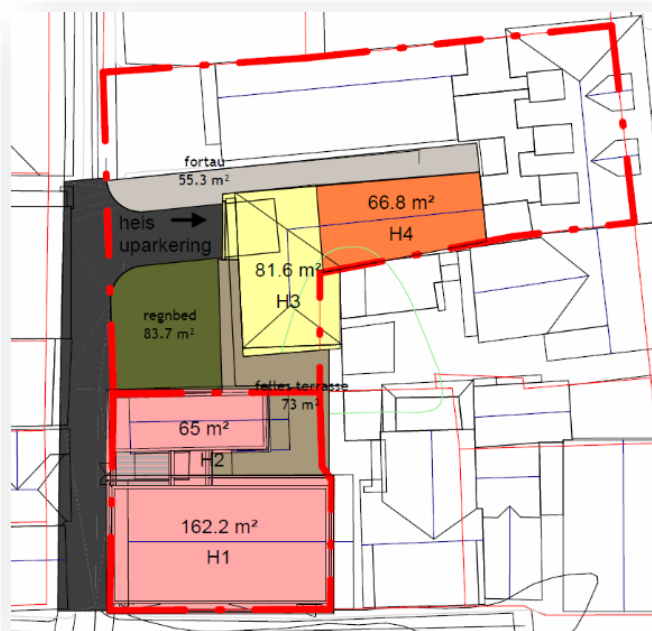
ALTERNATIV 1 – SITUASJONSPLAN FOR PLANLAGTE NYBYGG
